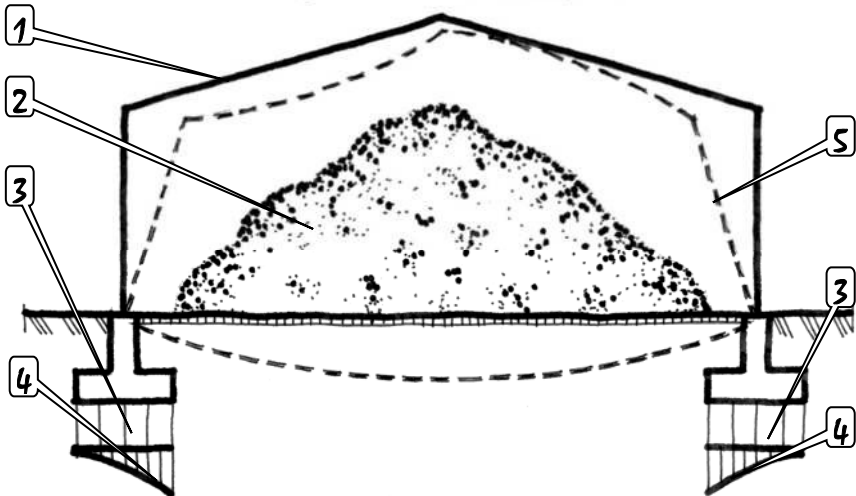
Деформації при перенавантаженні підлоги будівлі сипким матеріалом: 1 – проектне положення будівлі; 2 – сипкий матеріал; 3, 4 – епюри осідань фундаментів до і після укладки сипкого матеріалу; 5 – положення будівлі після деформації її несучих конструкцій
